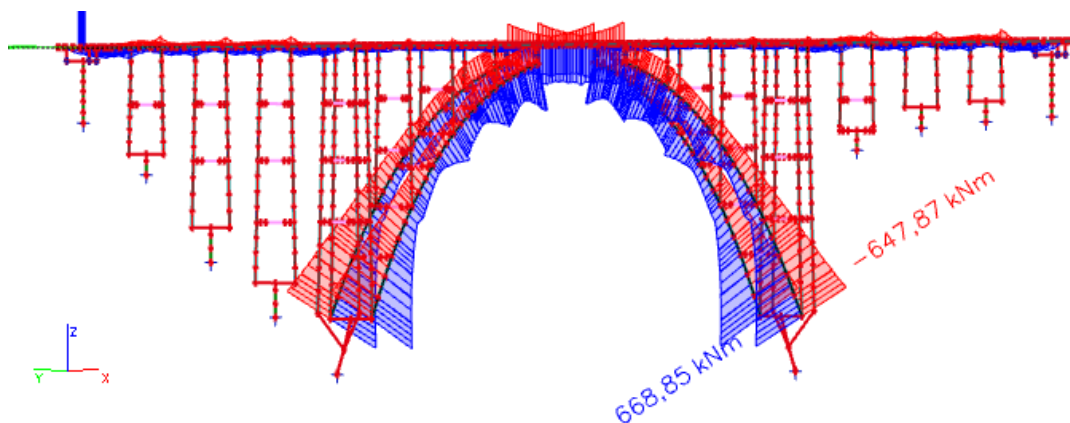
Normální zatížitelnost – umístění dvounáprav na konstrukci – varianta 3
